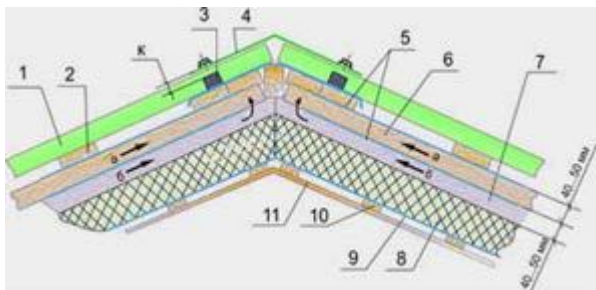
Утепленная кровля: 1 - профнастил (металлочерепица); 2 - обрешётка; 3 - уплотнитель коньковый; 4 - конёк; 5 - гидроизоляционная пленка; 6 - стропильная планка (брус контробрешетки); 7 - стропильная нога; 8 - утеплитель; 9 - пароизоляционная плёнка; 10 - потолочная рейка; 11 - гипсокартон, вагонка; а - продкровельная вентиляция; б - вентиляция между утеплителем и гидроизоляционной пленкой
